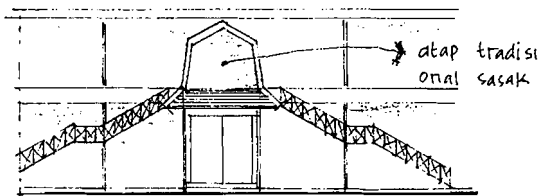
Bangunan rumah toko yang ada disekitar Terminal
